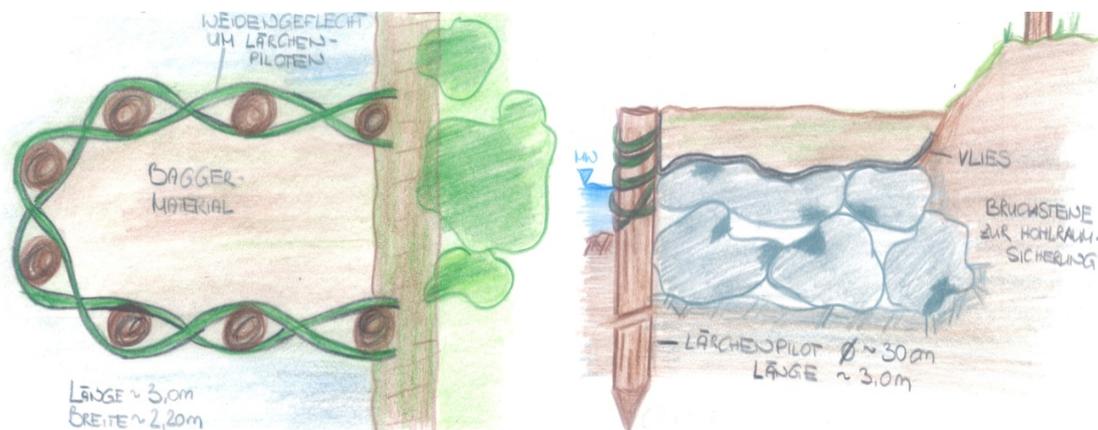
Grundriss (links) und Querschnitt (rechts) der von *Ing. Manfred Marko* (Baubezirksleitung Liezen) konzipierten Kurzbuhne (Abbildung der Darstellung in Originalgröße siehe Anhang IV-12)
